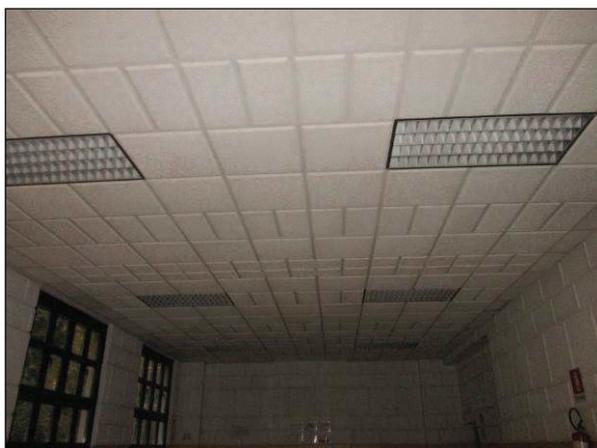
Individuazione della Tipologia Controsoffitto n°2, realizzata con pannelli in sughero ed installata nella Mensa al piano rialzato.
